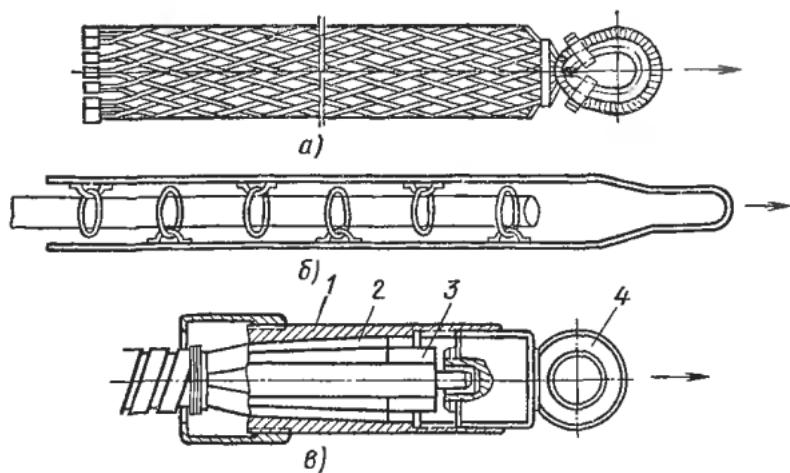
Приспособления для захвата конца кабеля при механизированной прокладке:
